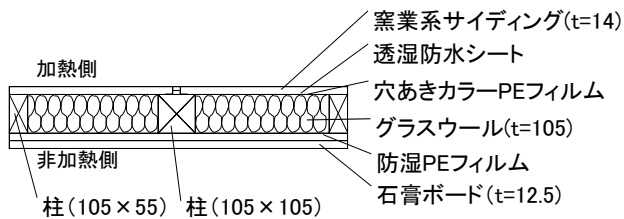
実験 No. 12 で使用した試験体断面図 [mm]
